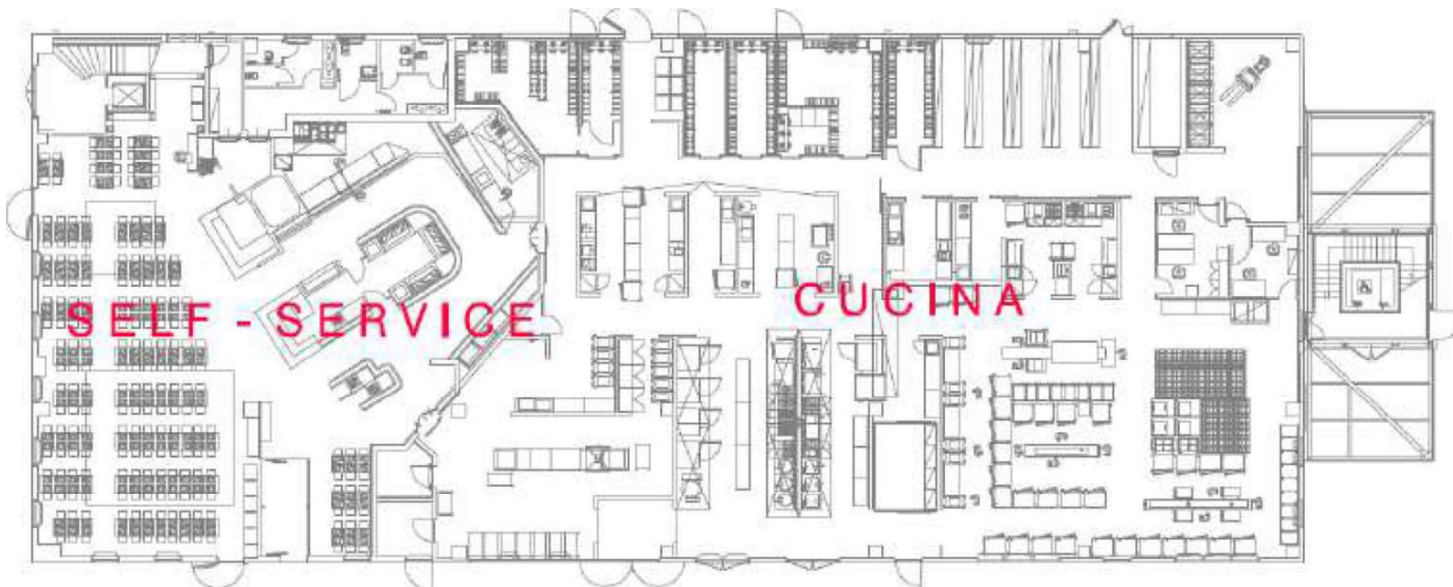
Sito di via della Punta 21-23 - Planimetria piano terra: centro cottura e self-service
